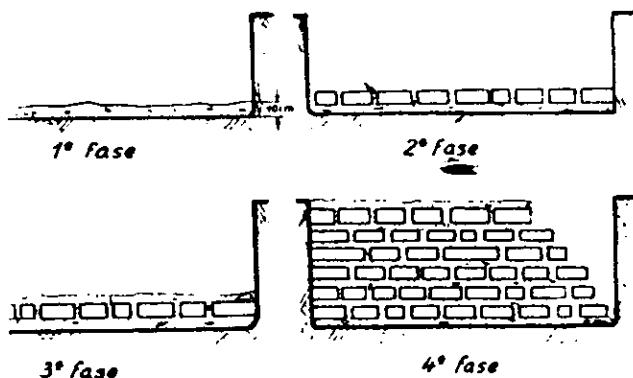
Construcción de un cimiento de mampostería hormigonada
